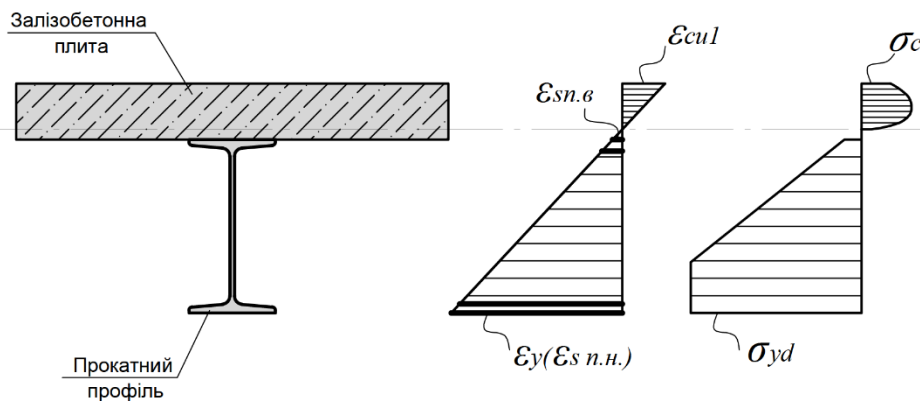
Поперечний переріз класичної сталезалізобетонної балки
